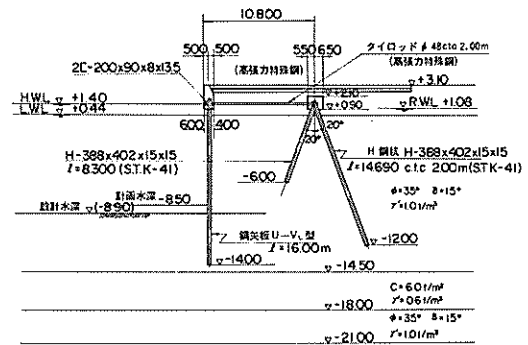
仙台港フェリーふ頭第1バース (-8.5 m) 標準断面図
